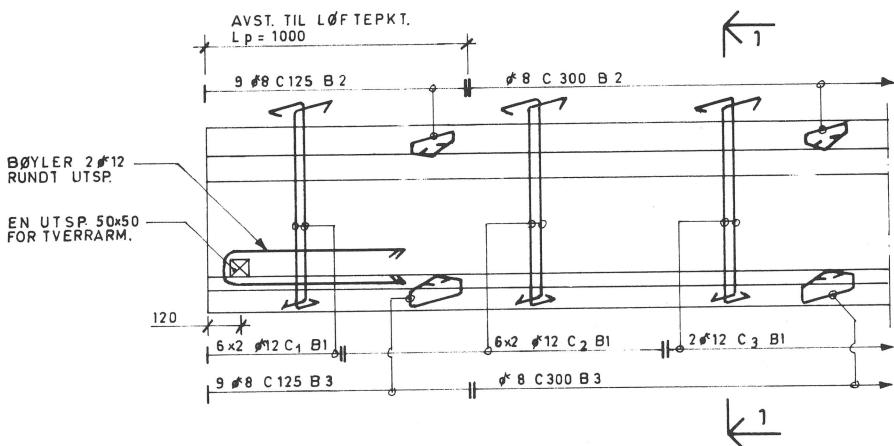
Bøylearmering bjelke. Oppriss. Snitt 1 - 1 er vist på fig. 096.7.
